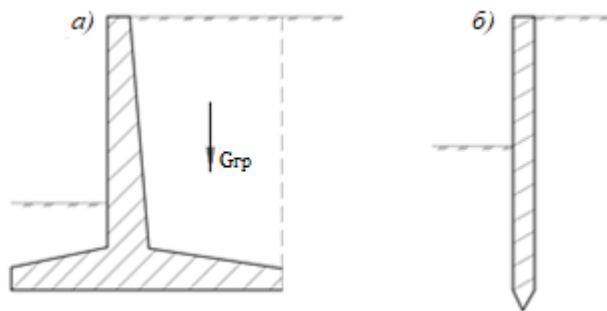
Тонкие и шпунтовые подпорные стены
